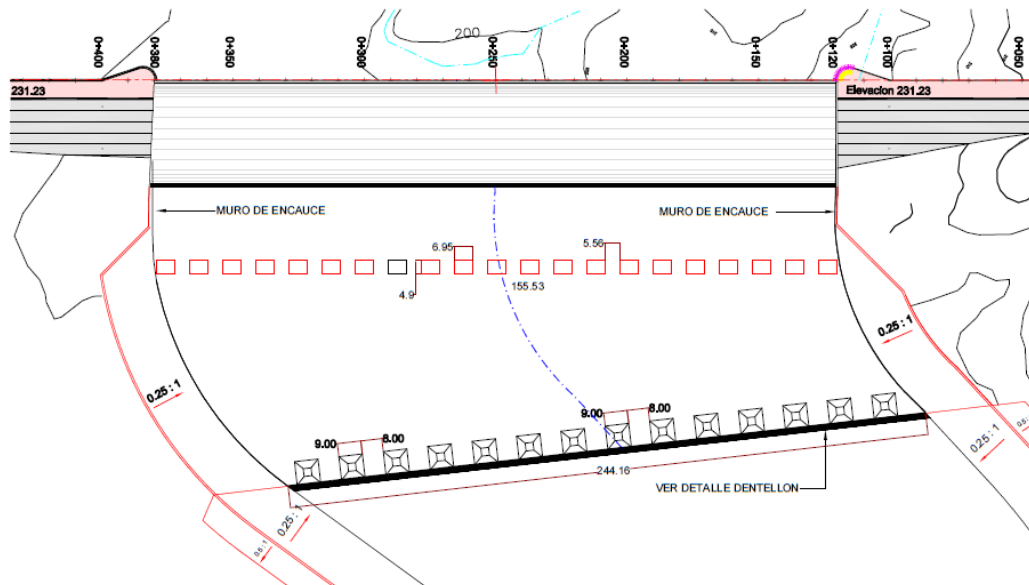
Propuesta final en planta de la obra de excedencias en prototipo
